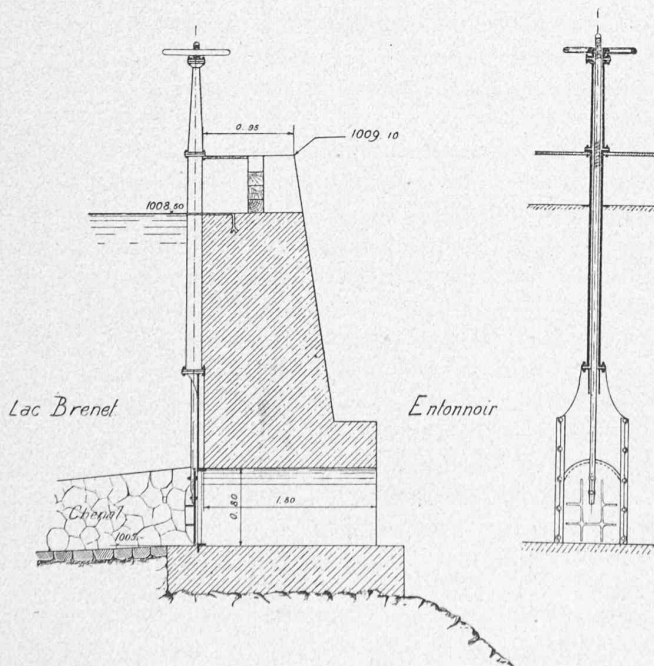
Coupe en travers d'un barrage des entonnoirs.
